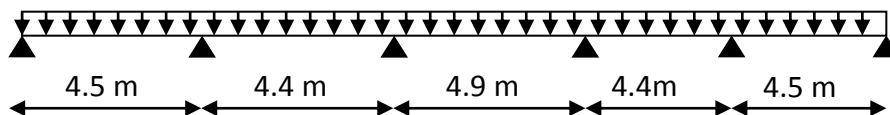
Schéma statique d'une poutrelle d'étage courant type 2
